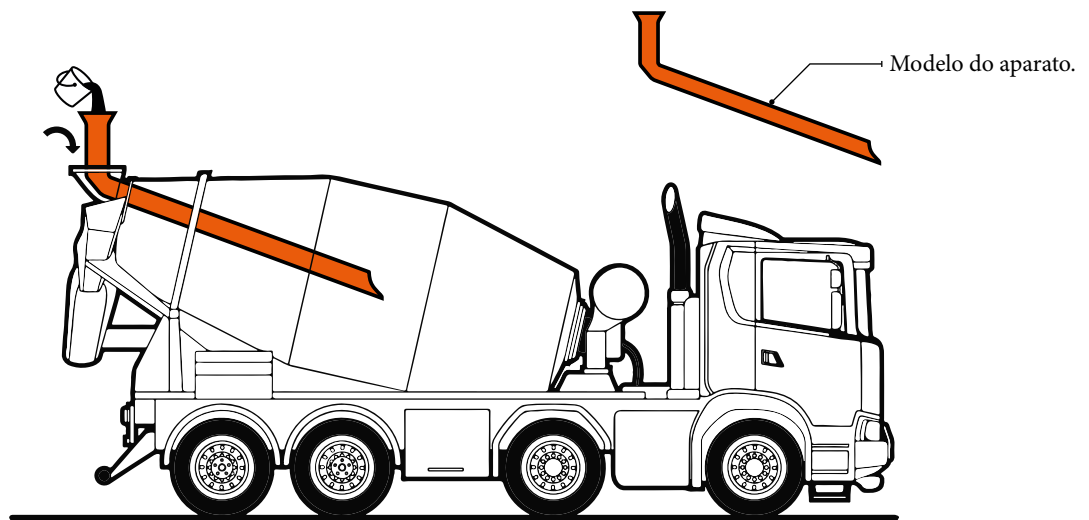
Aparato para adição dos aditivos no fundo do balão do caminhão betoneira.
